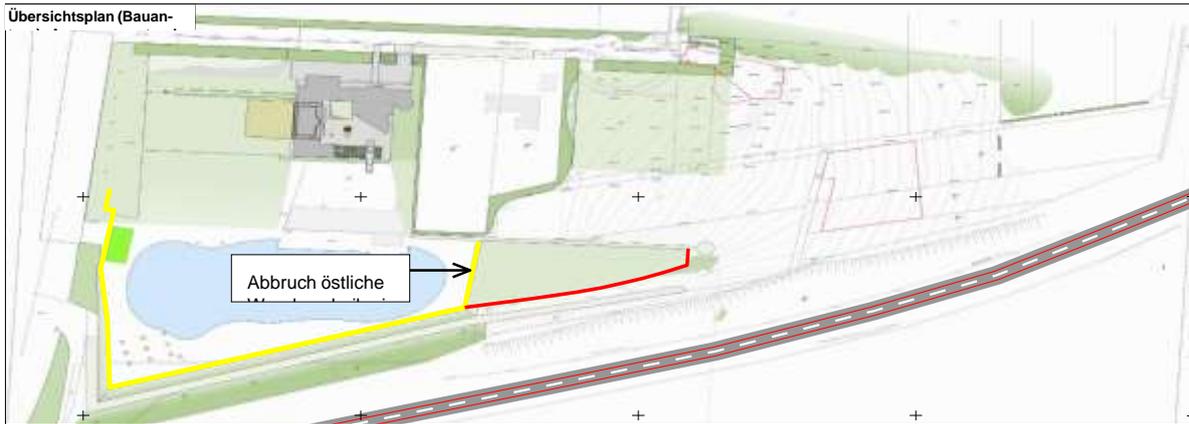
Übersichtsplan Lage der Lärmschutzwand – neu/rot –
